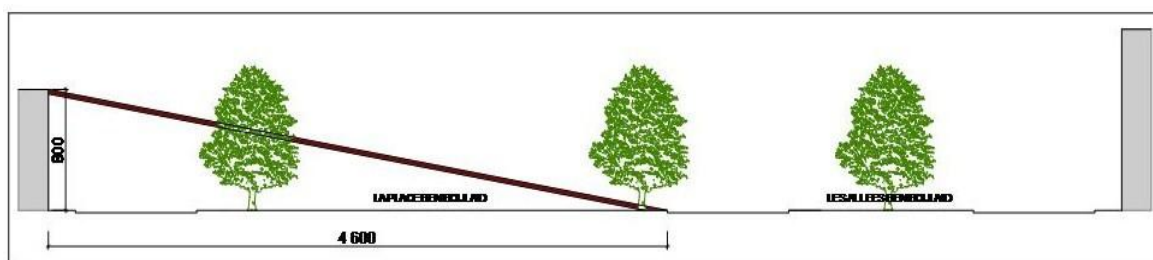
rapport entre la longueur et la largeur du plan, place Ben Boulaid.
